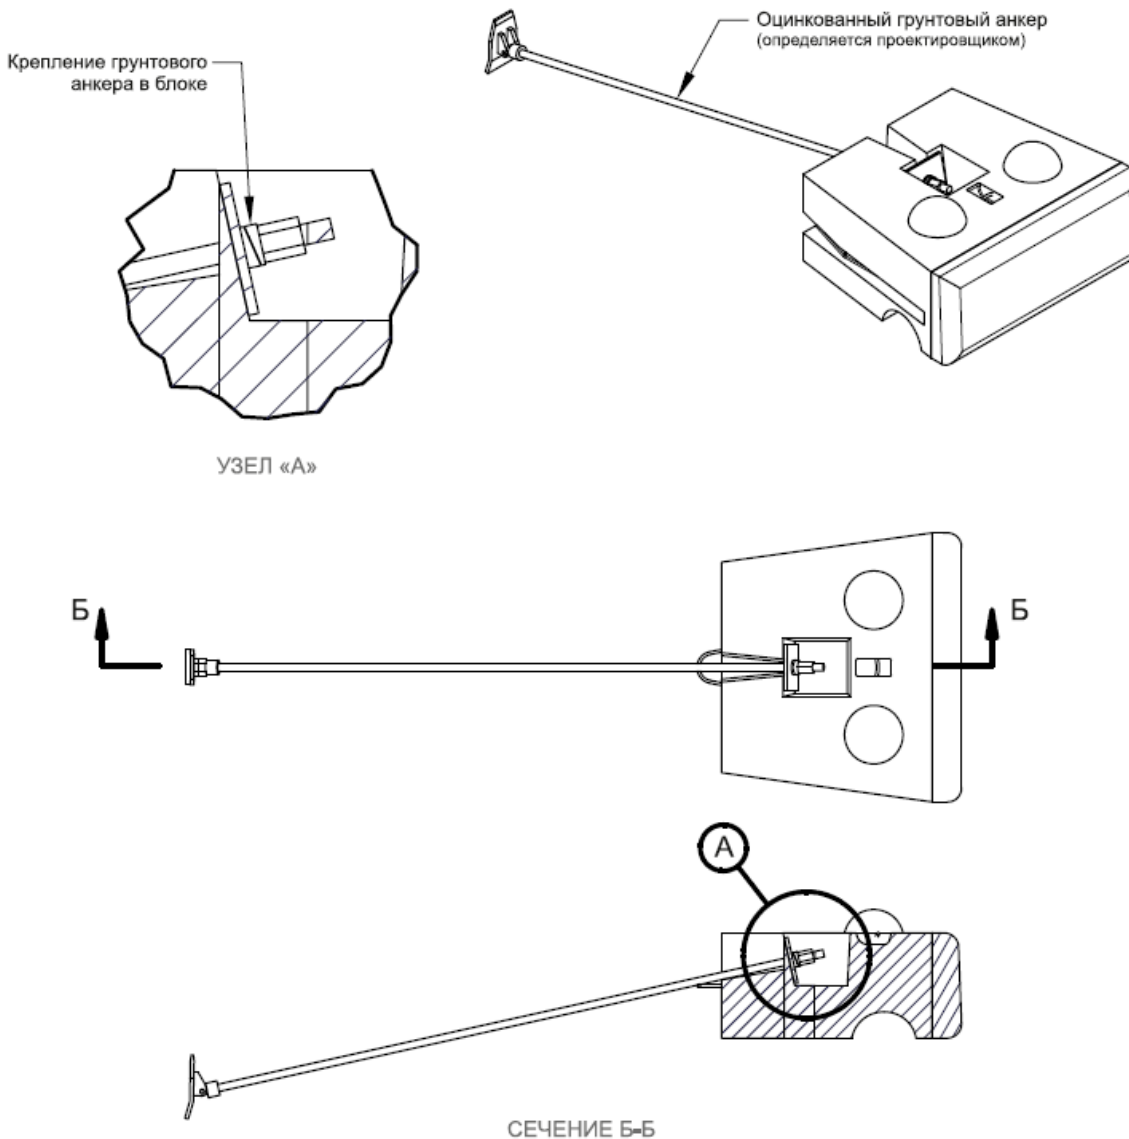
Способ крепления грунтового анкера в блоке
